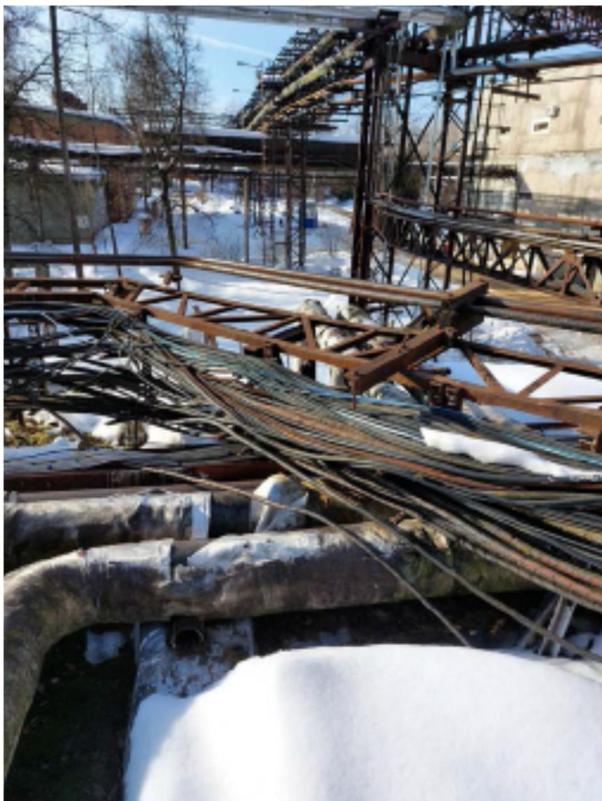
Нарушение изоляции трубопроводов. Сплошная коррозия изоляции кабеля. Кабель лежит навалом и с провисанием.
